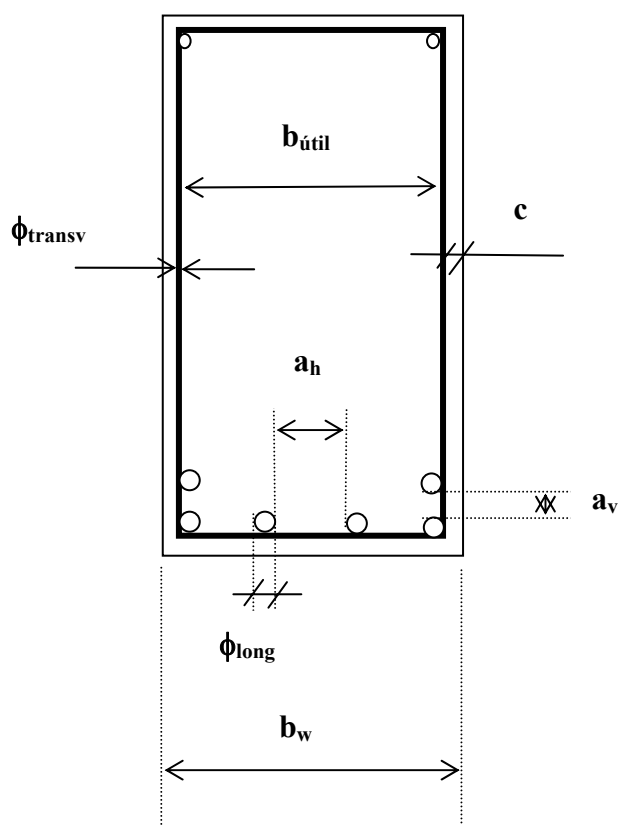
Distribuição transversal das armaduras longitudinais
